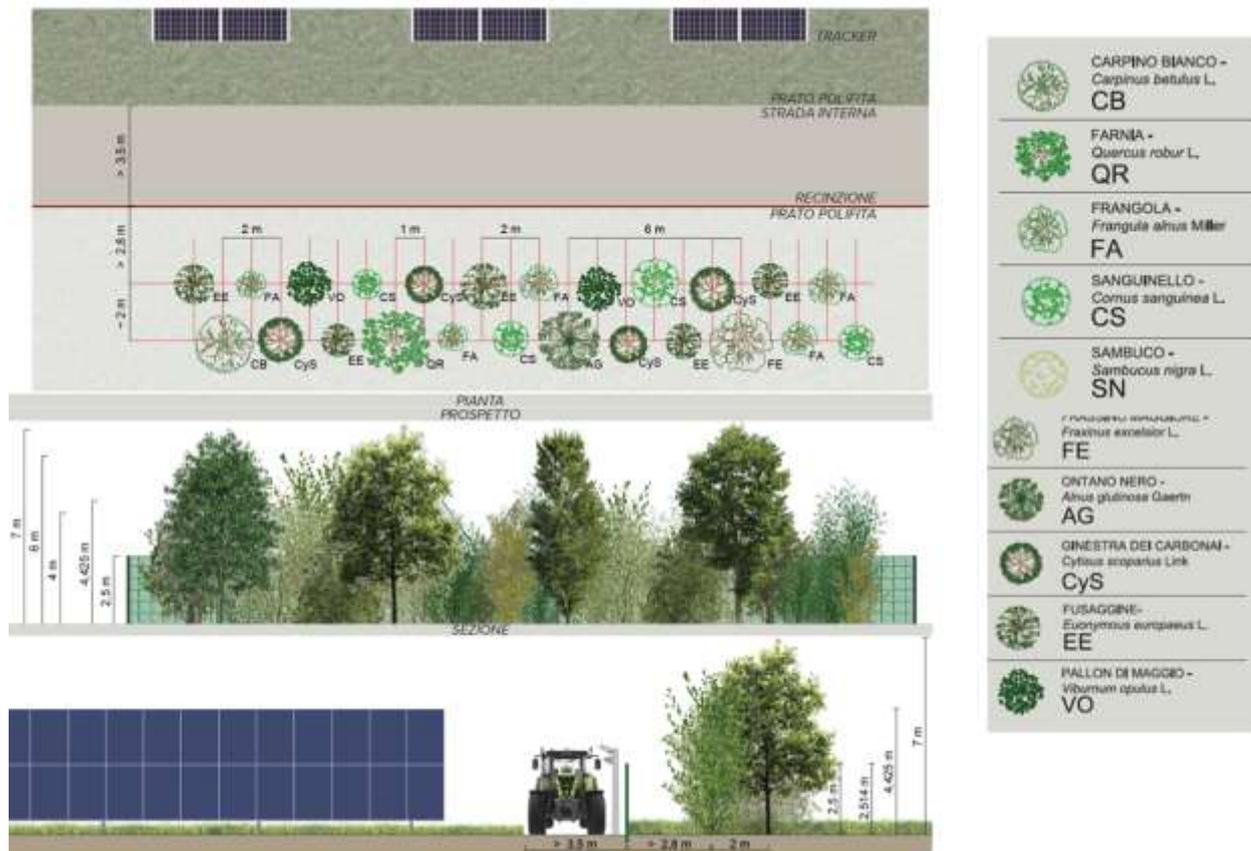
Il sesto d'impianto delle fasce di mitigazione a doppio filare di Tipo 2
